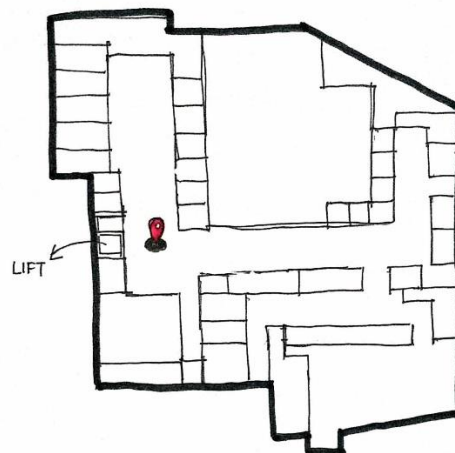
Sketsa floor plan Ambarukmo Plaza
